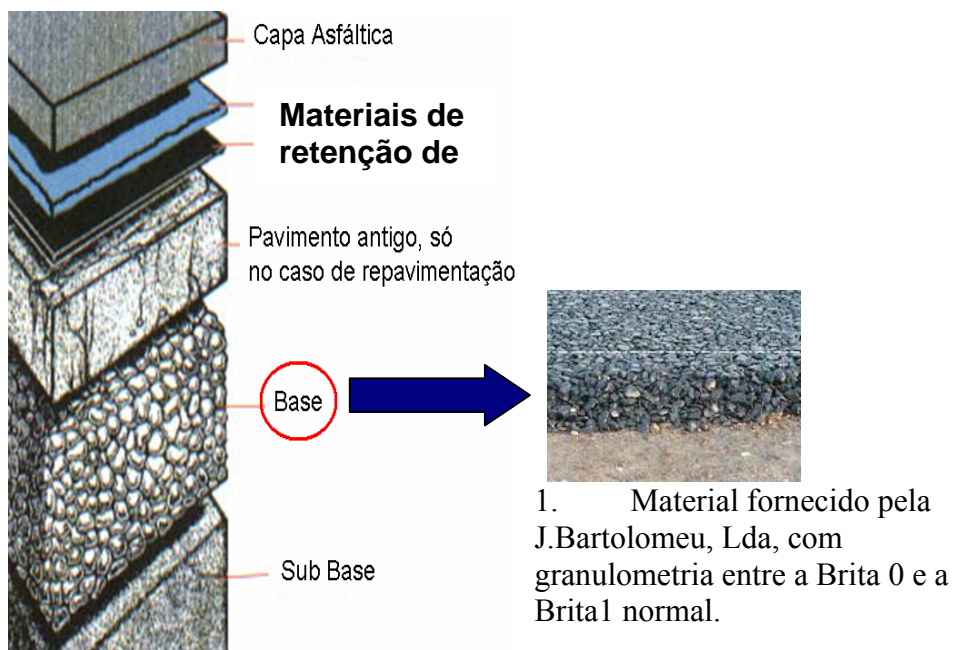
Camadas da Pavimentação (Sub-Base, Base e revestimento)
